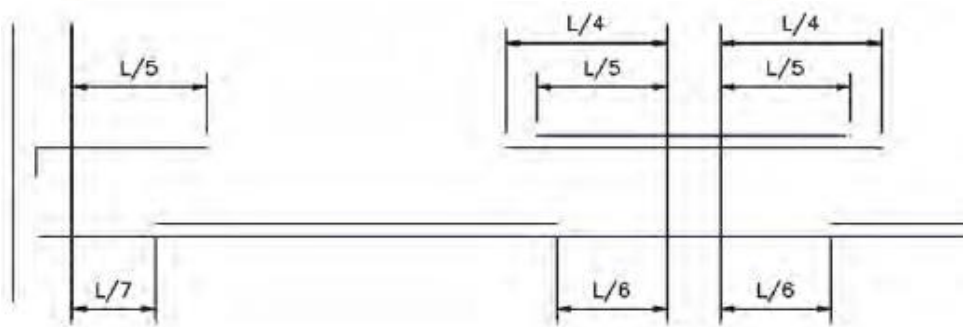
Cortes típicos de aceros de refuerzo longitudinal en vigas.
